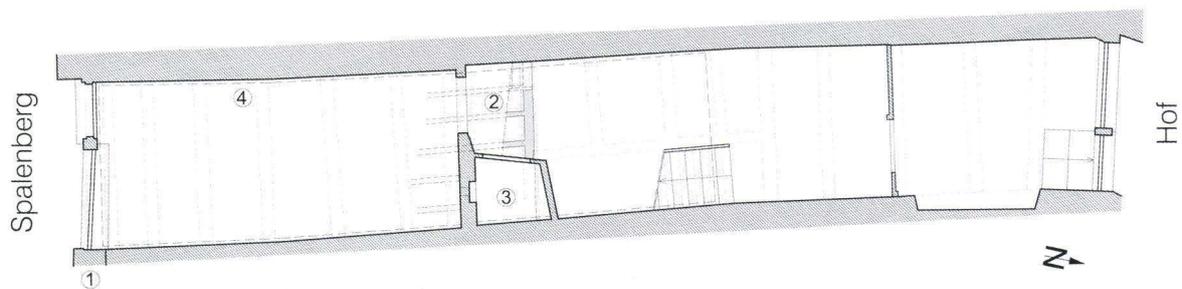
Spalenberg 30. Erdgeschossgrundriss mit Kartierung der Befunde. – Plan: Philipp Ryffel und Hans Ritzmann.
